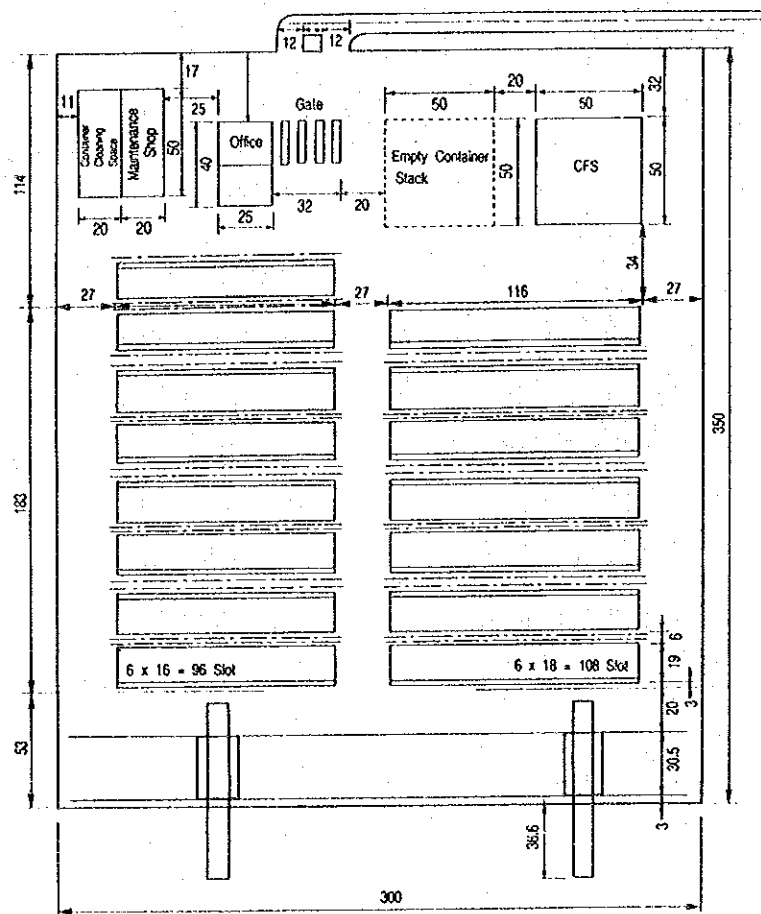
Plan a Corto Plazo del Sistema de Grúa de Trasbordo
